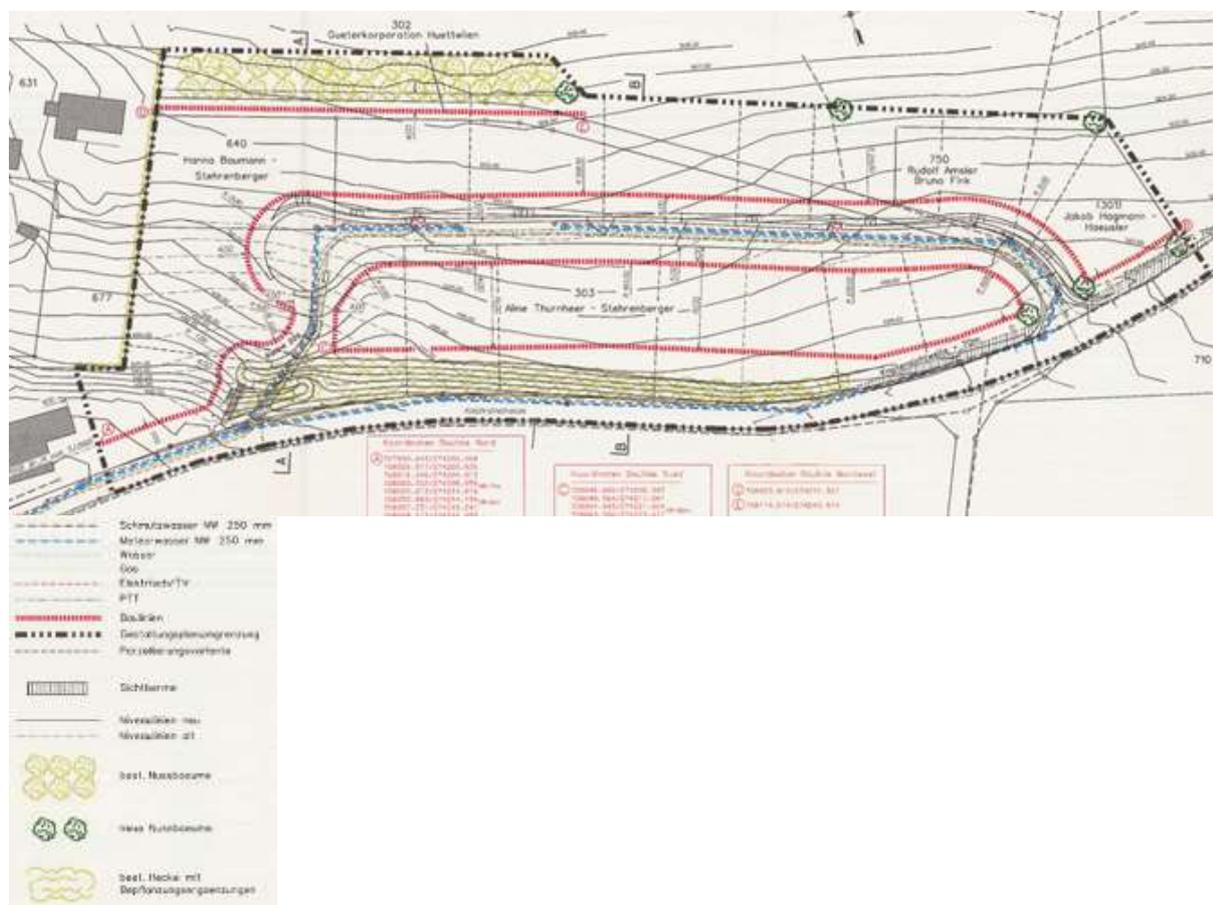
Ausschnitt Gestaltungsplan Wuli
